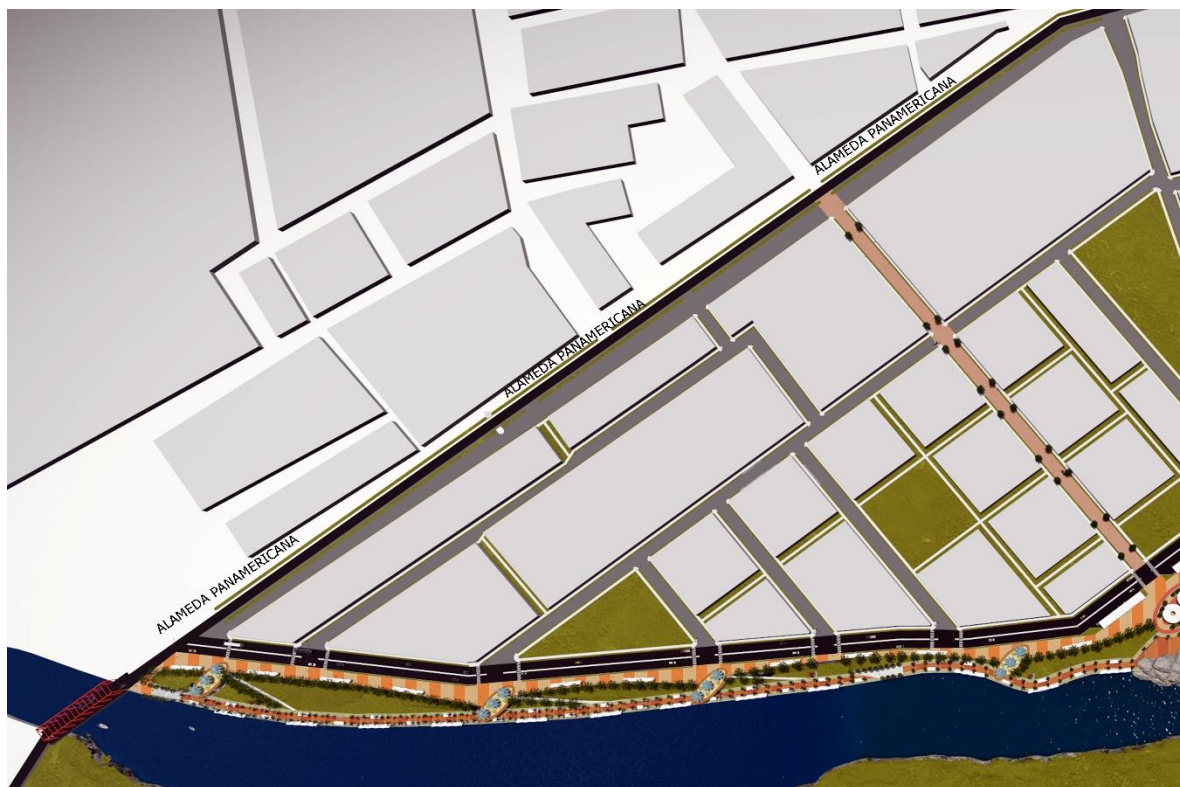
24 Planta de propuesta en alameda verde de la carretera panamericana
